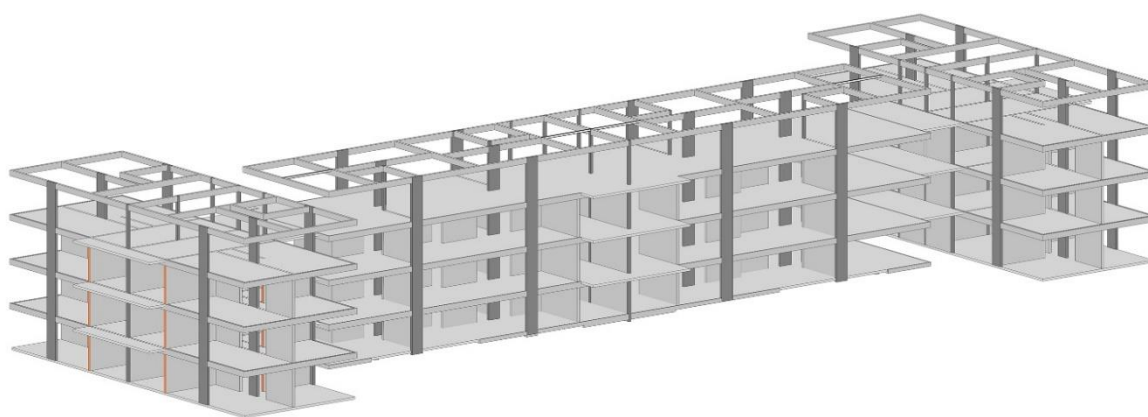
Vista assometrica tridimensionale della struttura portante dell'edificio
